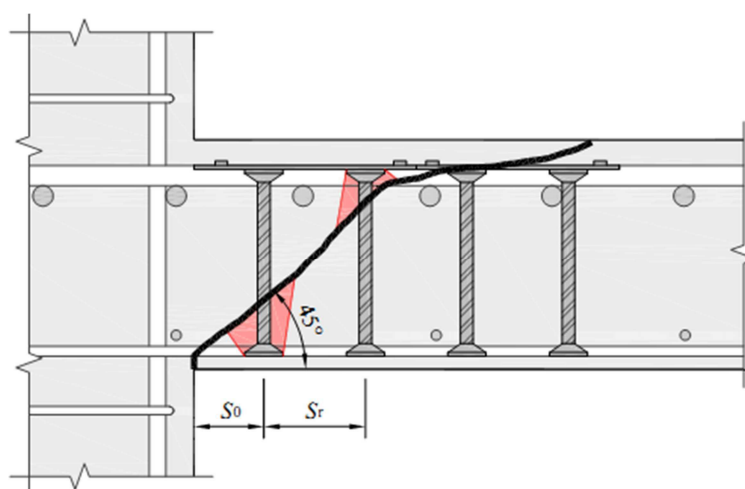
Ancoragem de *double-headed studs* em lajes lisas (Ferreira, 2010)
